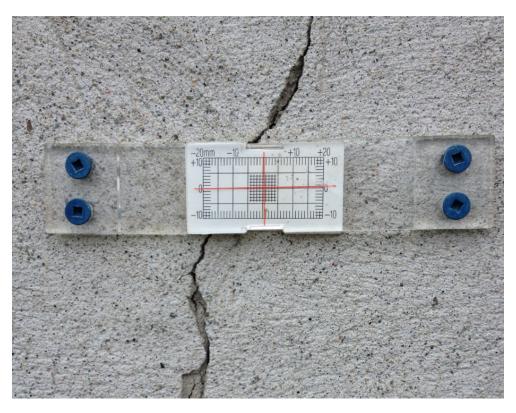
Fissuromètre installé sur le mur d'un bâtiment dans la ville de Malartic
